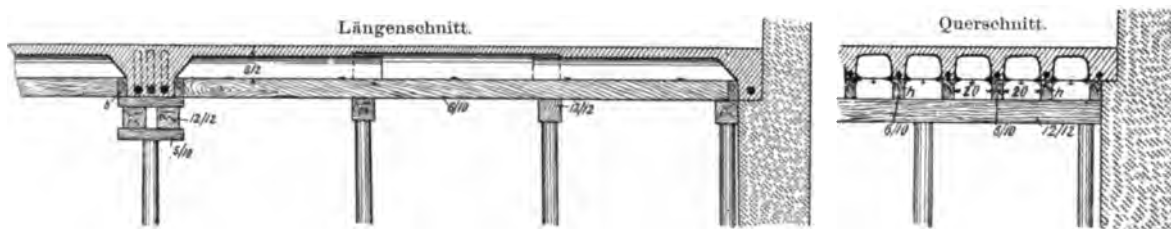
Verschalung einer Rippendecke mit Blechformen.
